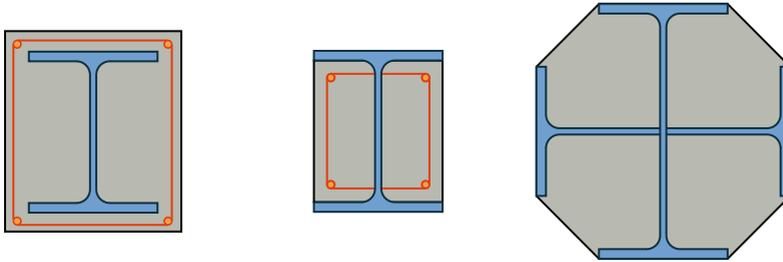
Sections de poteaux mixtes avec profilés totalement ou partiellement enrobés
